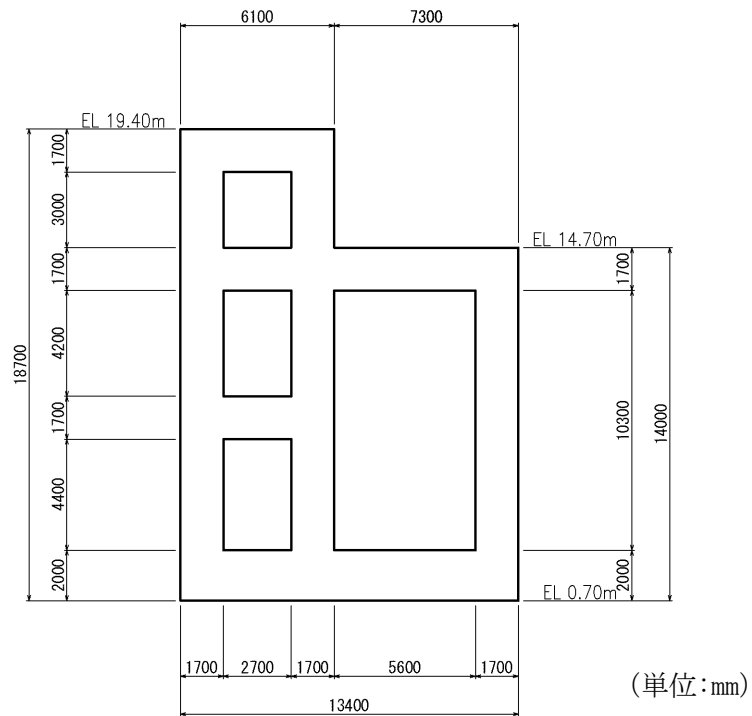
第1 ベントフィルタ格納槽 断面図 (A-A断面)
